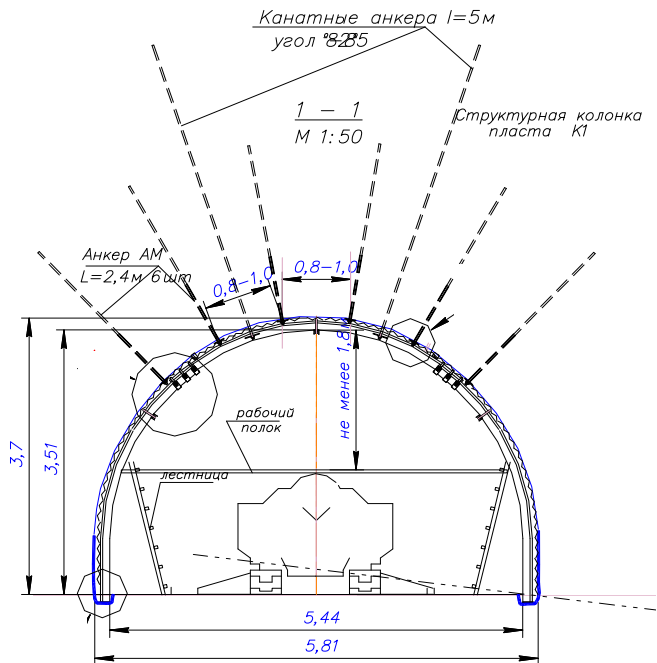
Структурная колонка и паспорт крепления вентиляционного штрека смешанной крепью и с использованием канатных анкеров
